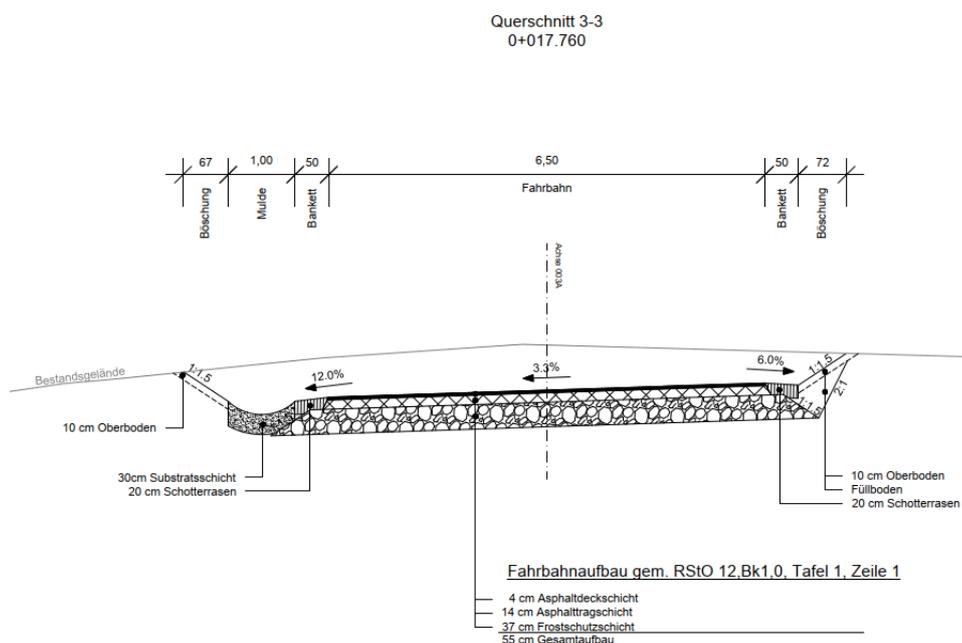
Straßenaufbau exemplarisch am Querschnitt 3-3
